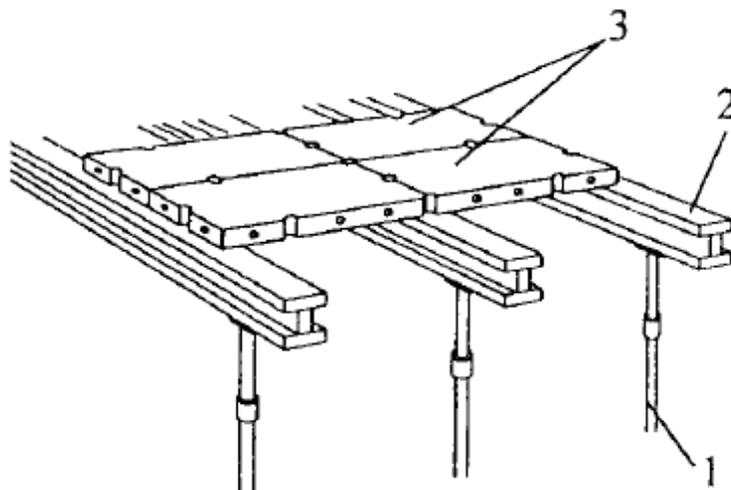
Опалубка перекрытий фирмы «НОЕ» с балками Н20:
